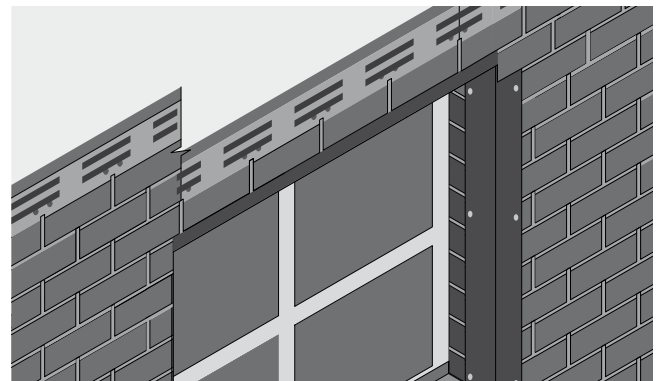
Монтаж фасадной плитки поверх оконного наличника сверху проема
